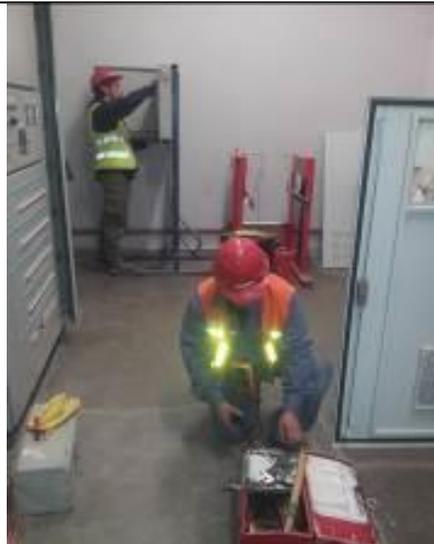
Tarea que realizaba el trabajador, intervenía un tablero sin consignación.
